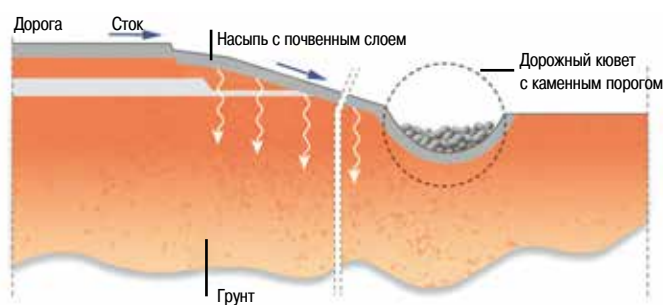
Схема удаления поверхностного стока в кювет, обустроенный порогами
